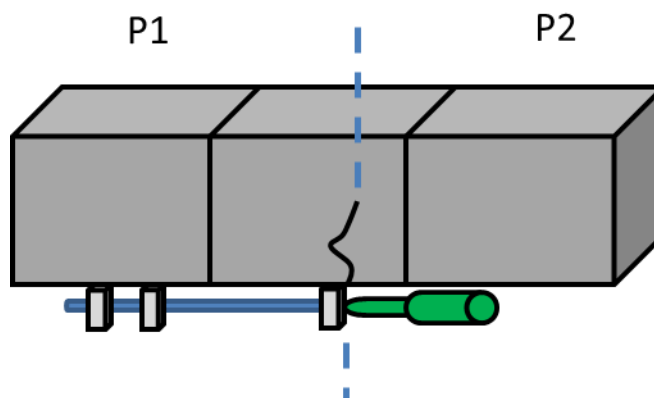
Vista elevación 3D, lados correspondientes a las fibras obtenidas luego del completo fisuramiento de la viga.
